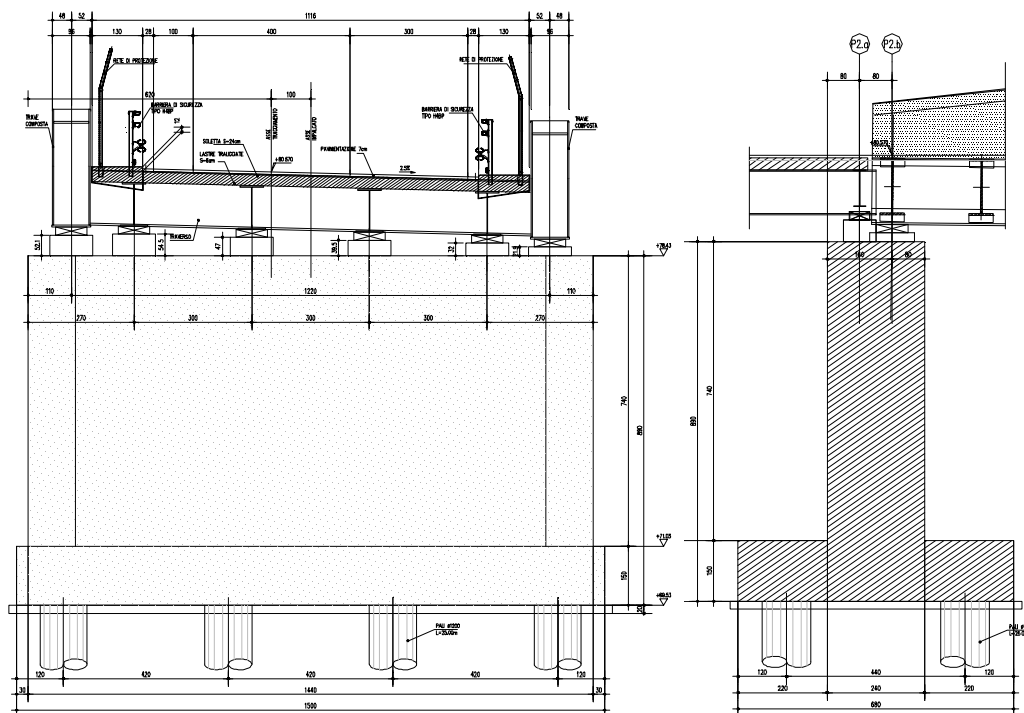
Pila P2 - Sezione in retto impalcato e sezione trasversale
